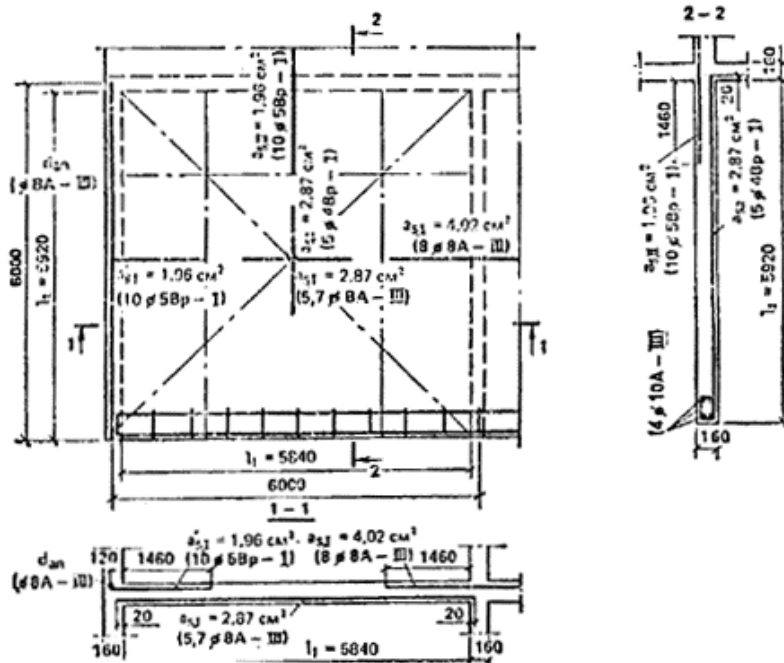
Схемы к примеру расчета монолитной плиты перекрытия
